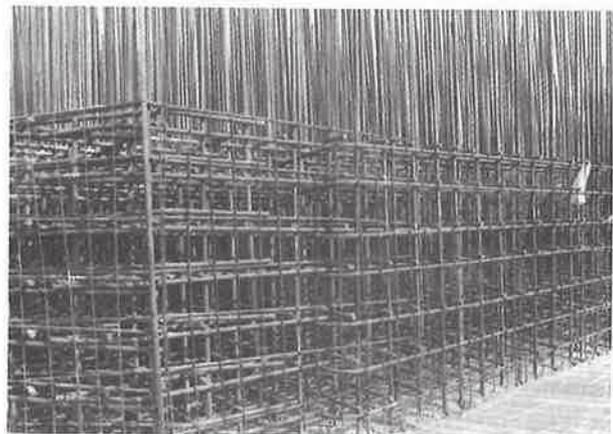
Vista di un elemento strutturale con elevata densità di acciaio di armatura
